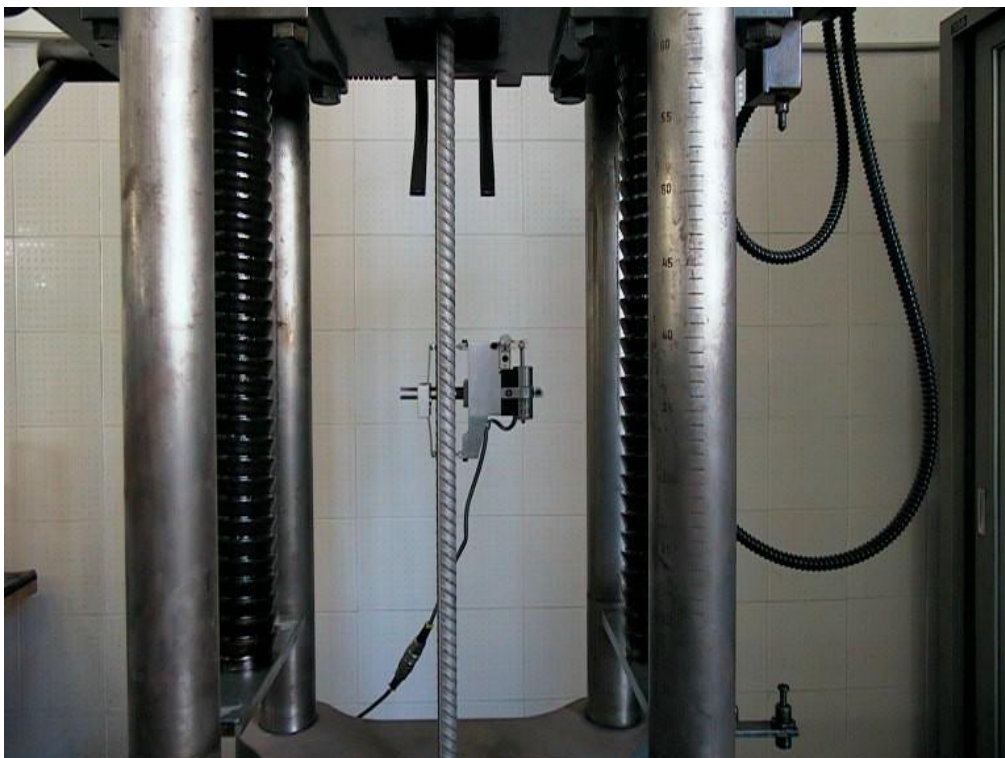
Prova di trazione su barra di armatura di acciaio
